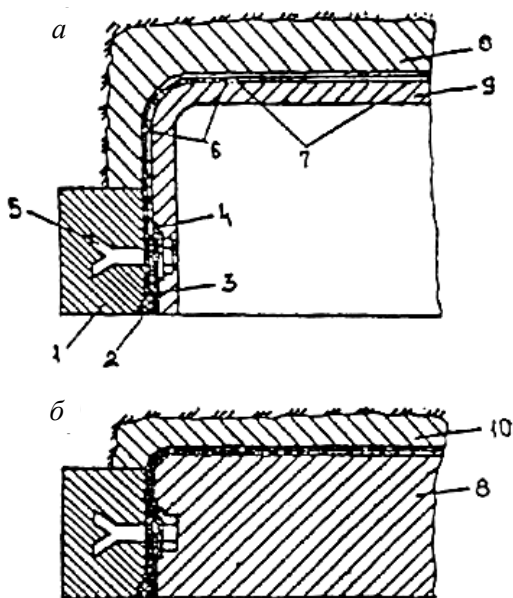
Схема сопряжения монолитной бетонной и блочной обделок:
